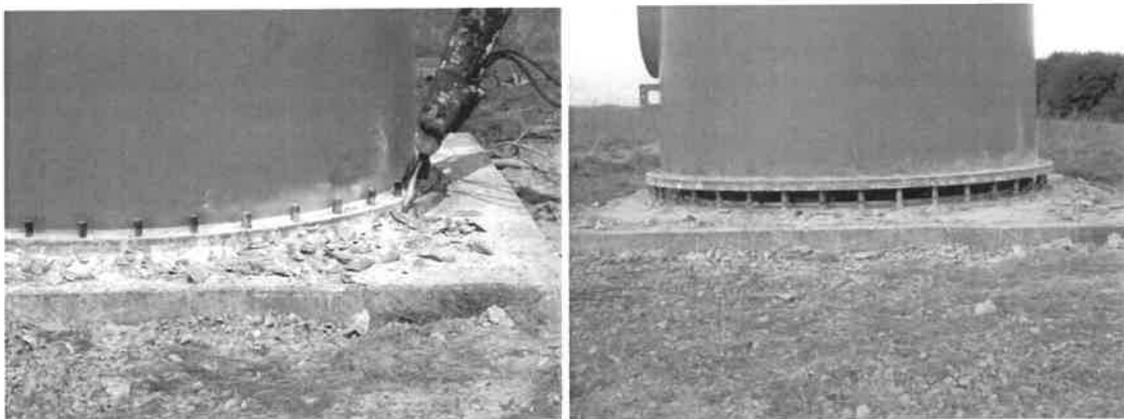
Démontage et soulèvement de la section inférieure d'un mât en acier avec cage d'ancrage
